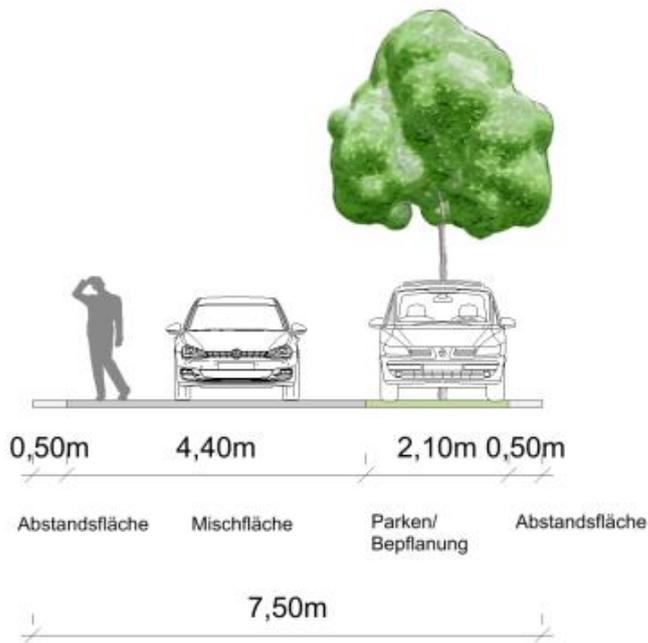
Möglicher Straßenquerschnitt Planstraße F,I und J (mit und ohne Parken)
